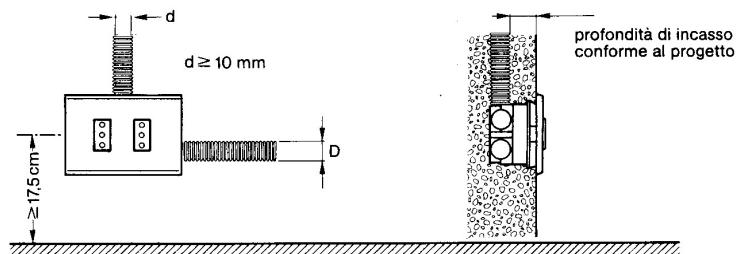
Criteri di installazione degli impianti incassati e similari
